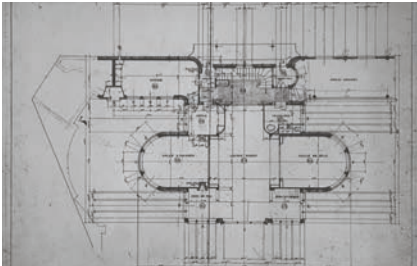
Plano en planta baja, 1916. Fondation Le Corbusier; La Chaux-de-Fonds, 1916-1917.
